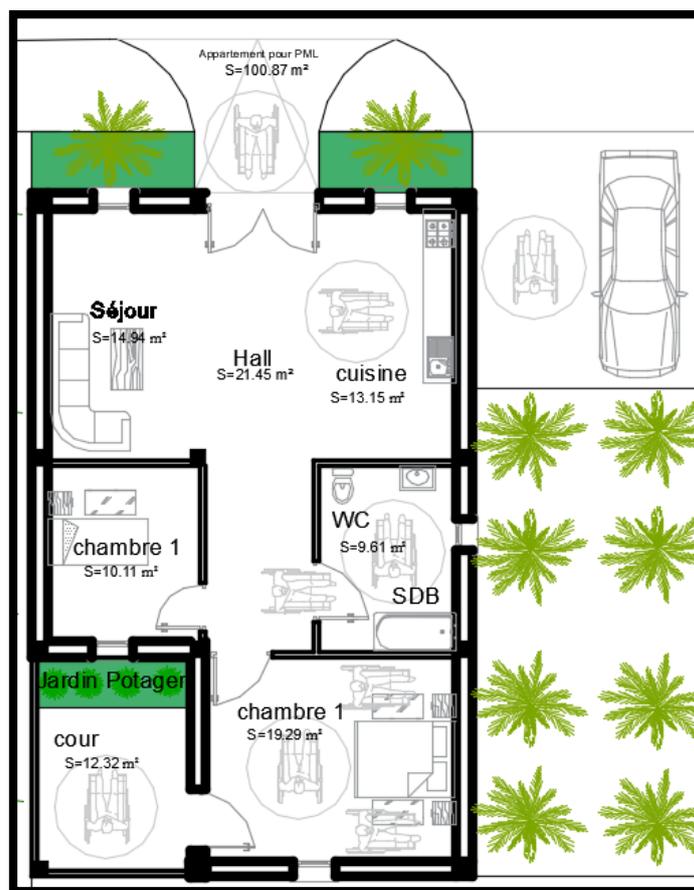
37 : plan d'appartement de PMR. Source : auteur
